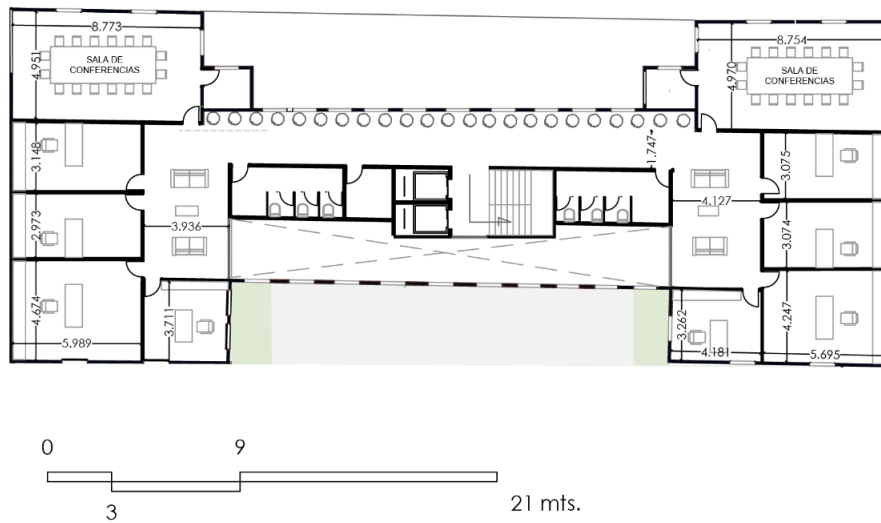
Propuesta Arquitectónica Oficinas Bloque 1
